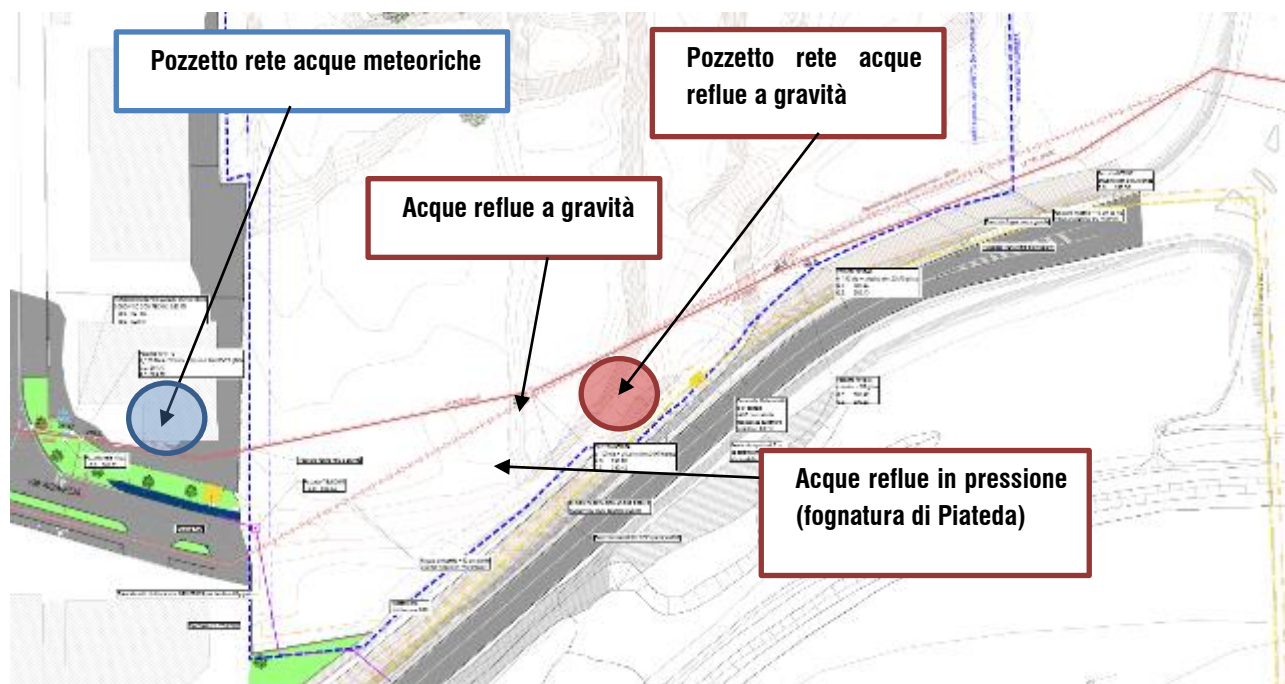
Estratto planimetria reti esistenti (elab. 00PC_OU_B001_20)
